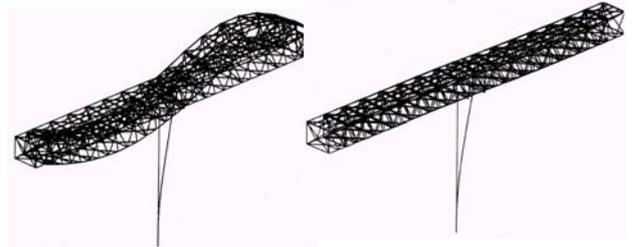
TYPE-1条件時の挙動 図-4 TYPE-2条件時の挙動
